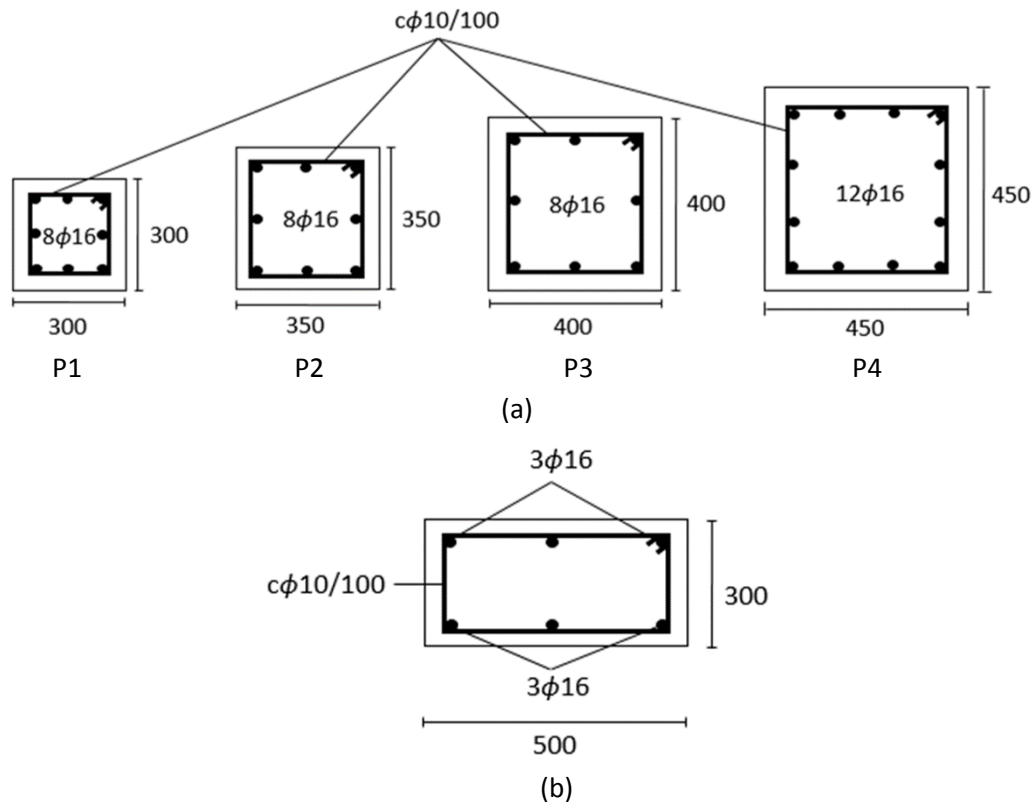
Secciones transversales del pórtico de 8 plantas. (a) Pilares. (b) Vigas.
